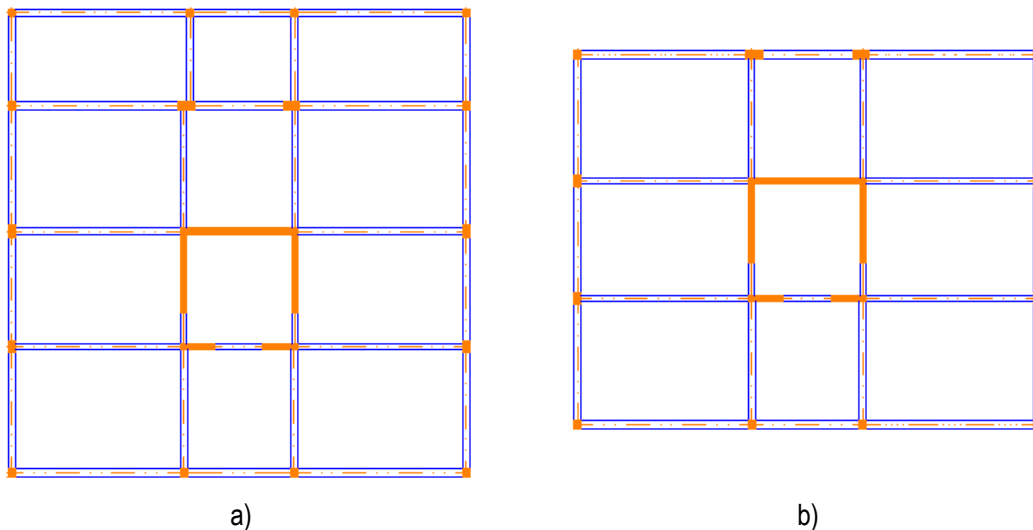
Plantas estruturais; a) Planta do rés-do-chão; b) Planta dos pisos correntes
